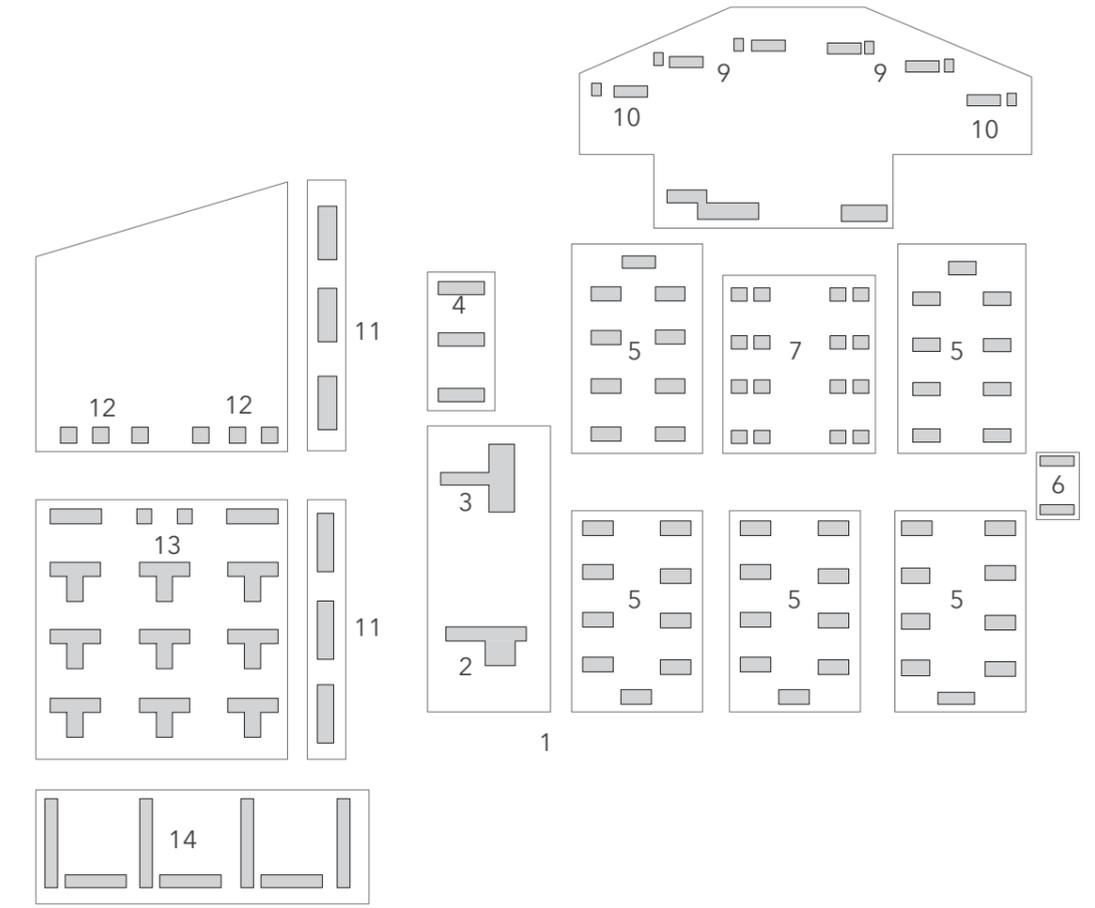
Grundrisschema Kibbuz Ein Hashofet, Israel
